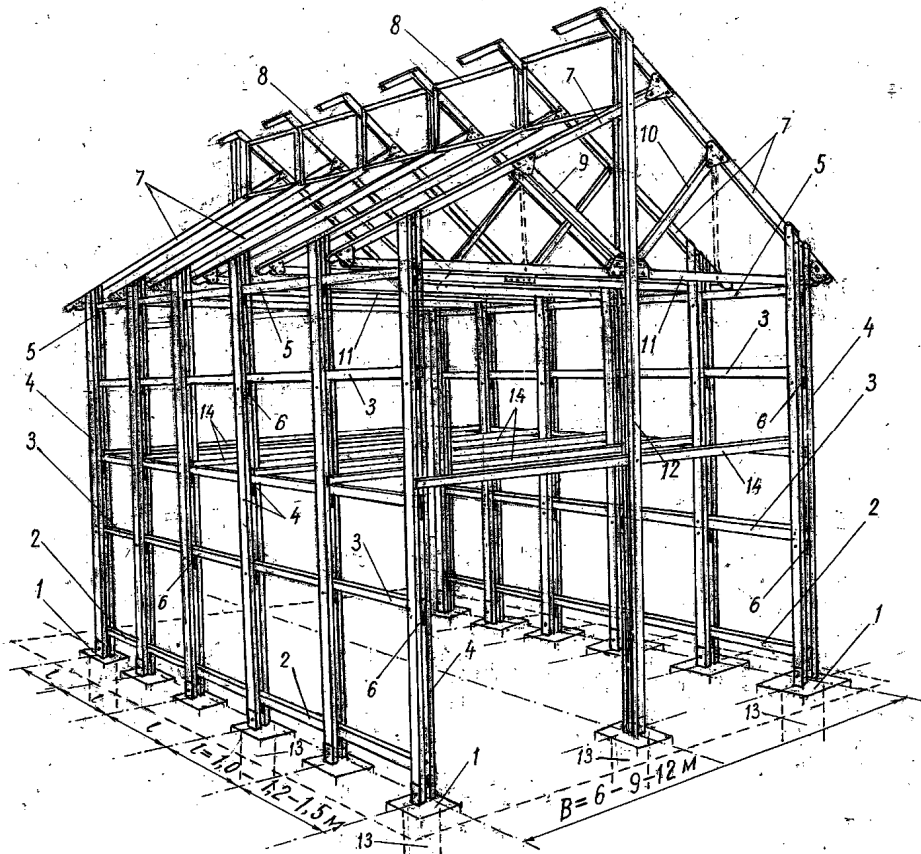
Легкомонтована універсальна каркасна система двоповерхового індивідуального житлового будинку. (Позначення збірних елементів на рис.1)
